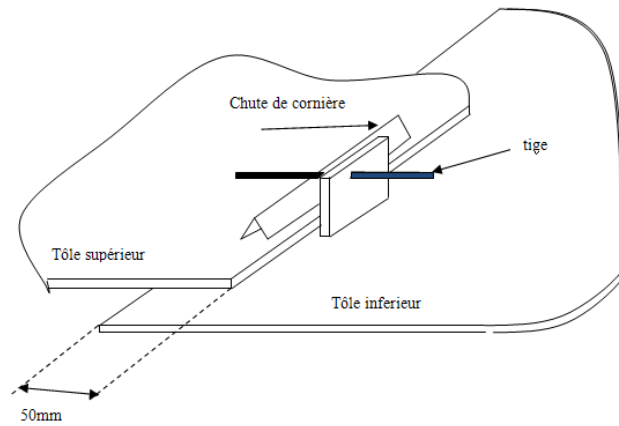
Assemblage par recouvrement (toit, fond)
